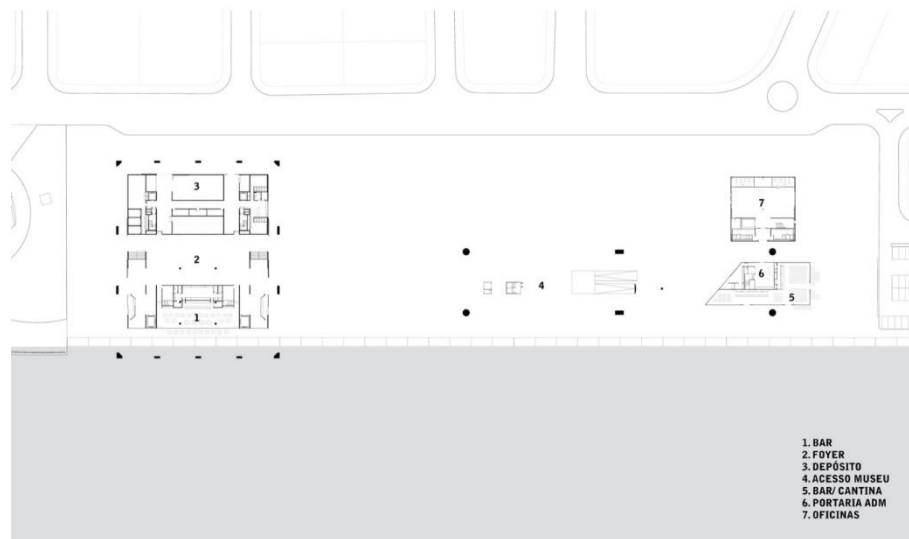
Planta de implantação, sem escala. Fonte: archdaily.com.br.
